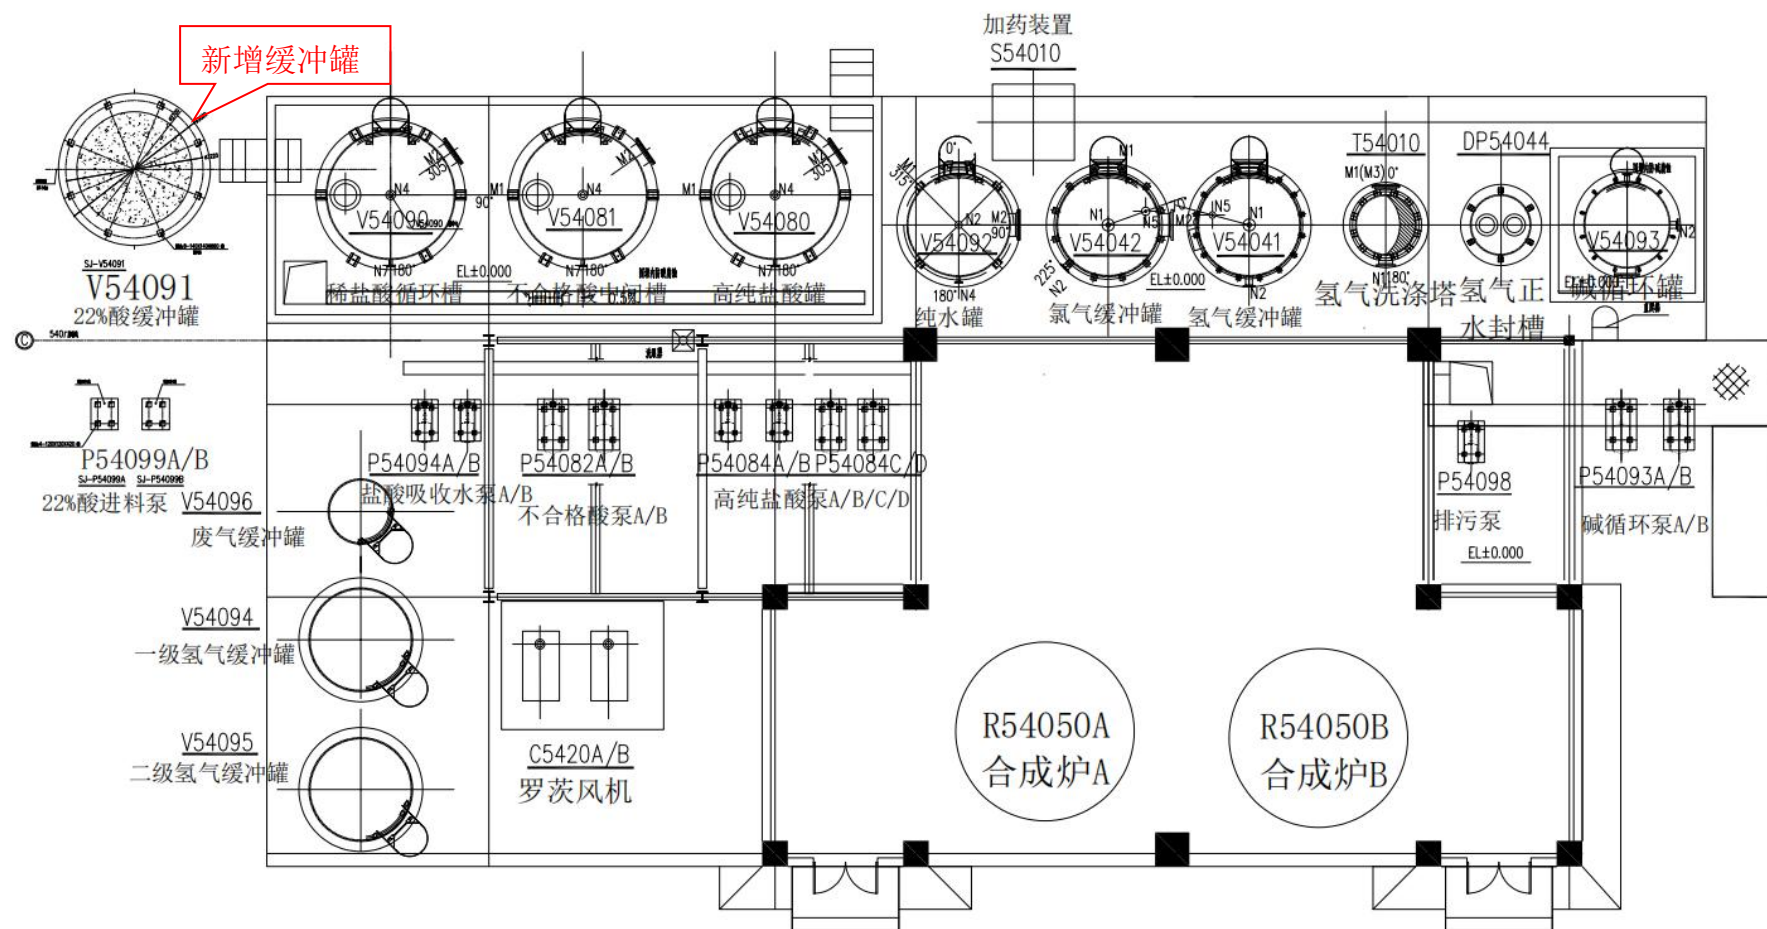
氢气处理及高纯盐酸合成车间平面布置图
